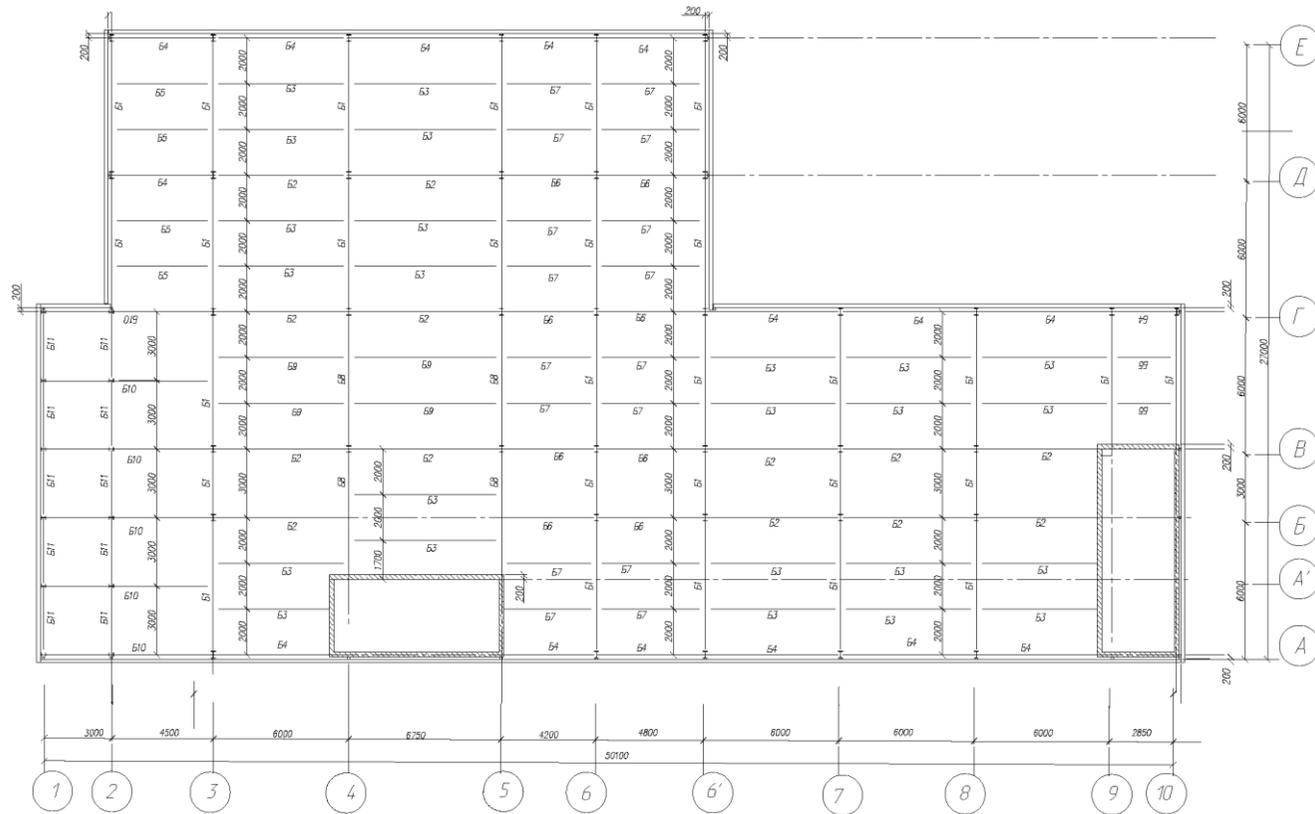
Схема расположения балок перекрытия на отм. +4,200
